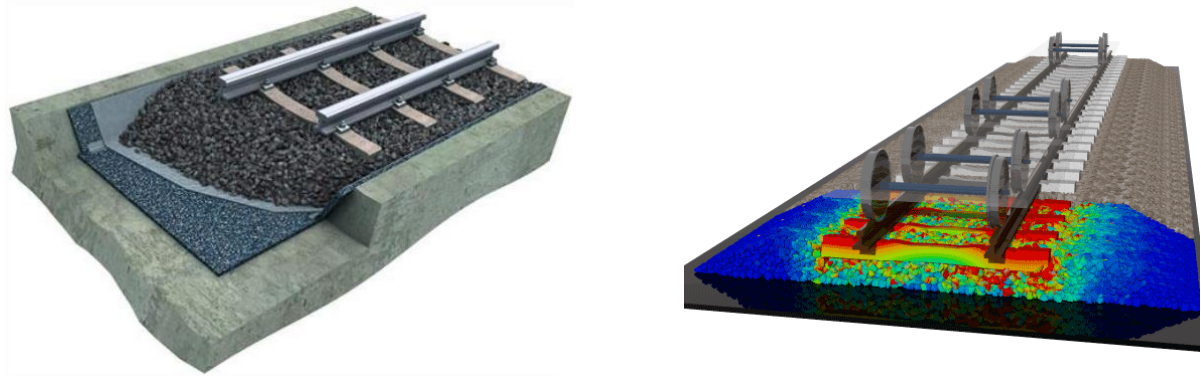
Estructuras real y modelo numérico. Instalación fija (traviesa, rail) y interactuando con el balasto.
